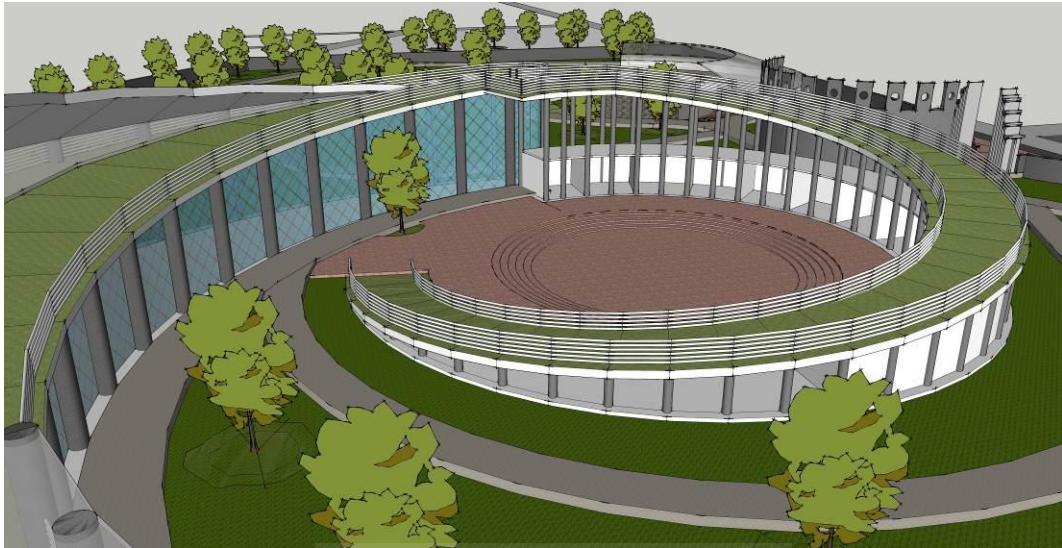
Rancangan Skematik Kawasan Tapak (*Site Plan*)
